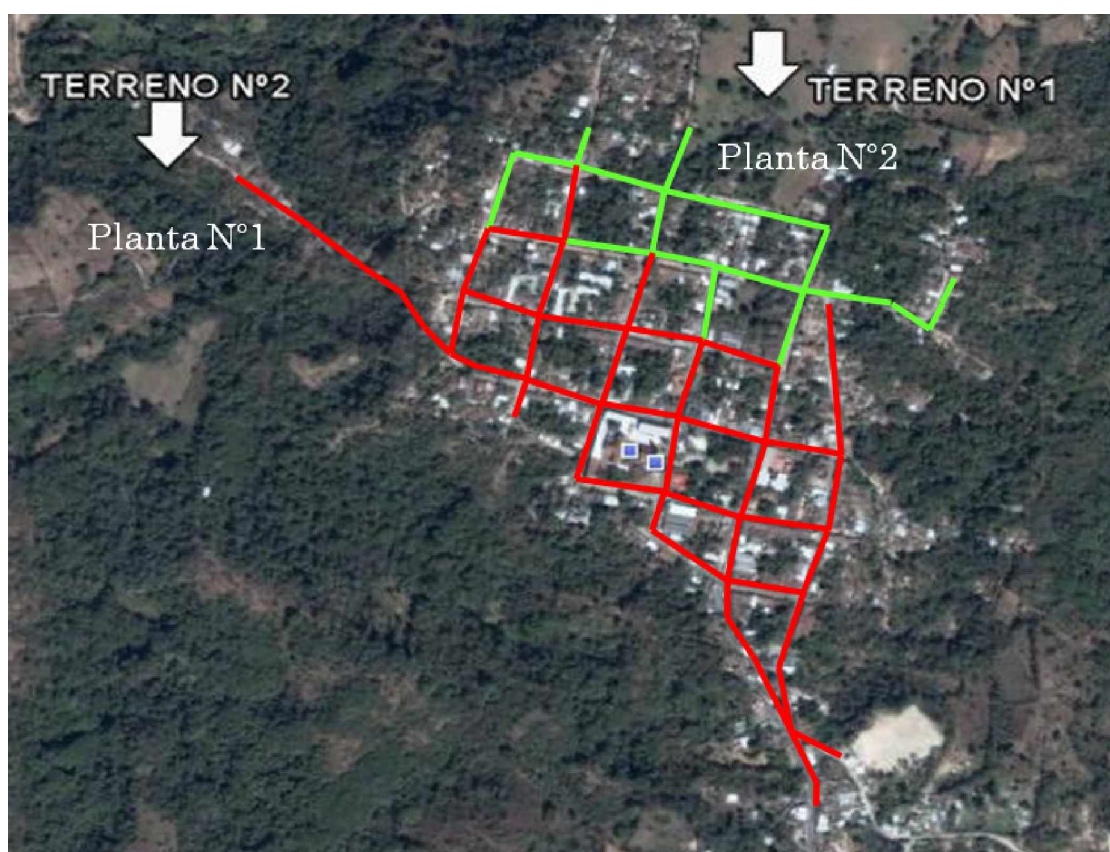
Esquema de la alternativa N°1 para el alcantarillado sanitario
